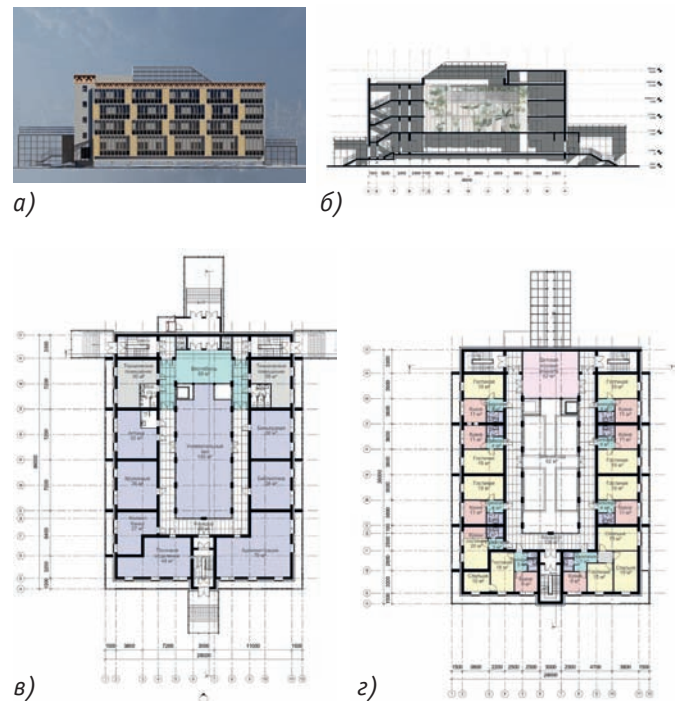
Прямоугольный в плане многофункциональный жилой комплекс (МЖК) с внутренним двором: а) главный фасад; б) вертикальный разрез; в) план 1-го этажа; г) план типового этажа
